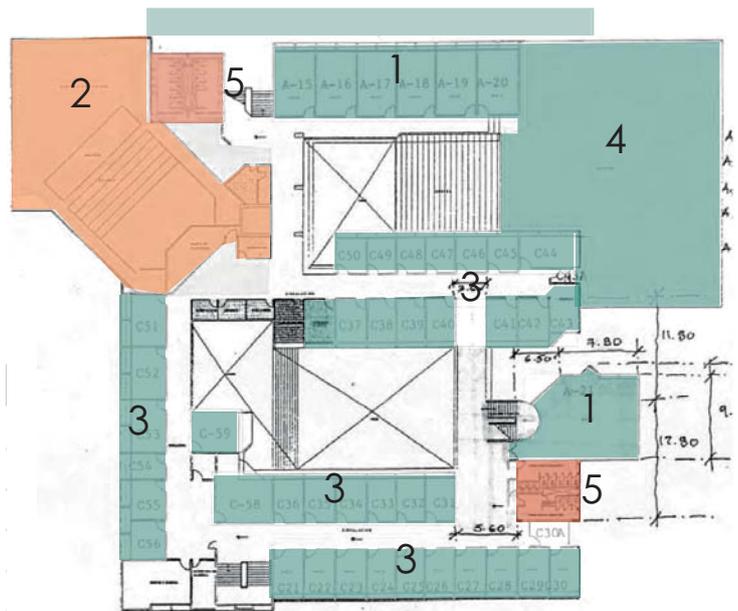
PLANTA ARQUITECTÓNICA, PRIMER NIVEL.
